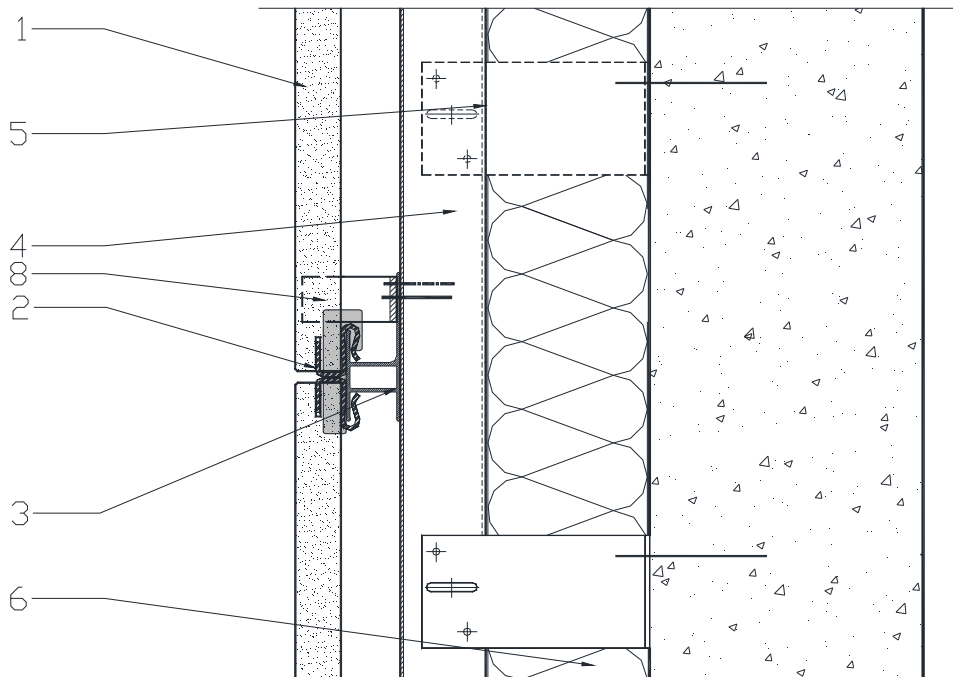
Principe de montage coupe horizontale (joint vertical)
